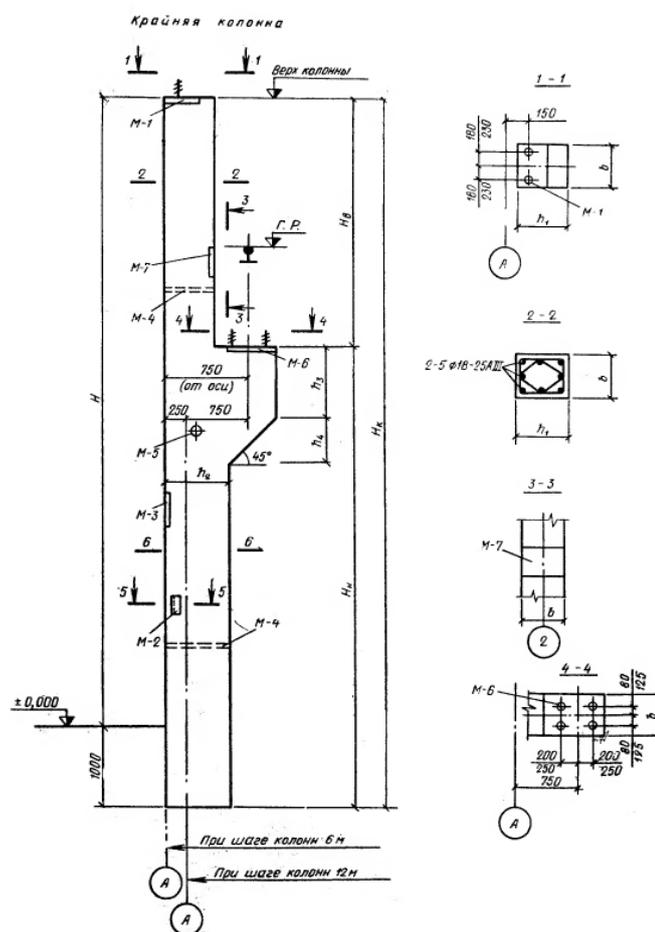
Схема крайних ж/бетонных колонн для зданий с
